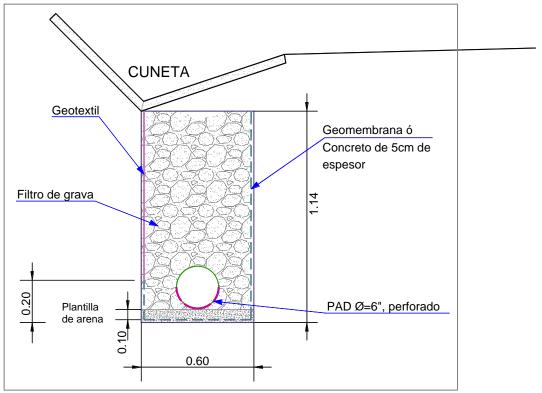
Estructura de subdrenaje en zanja, Detalle, 2018
